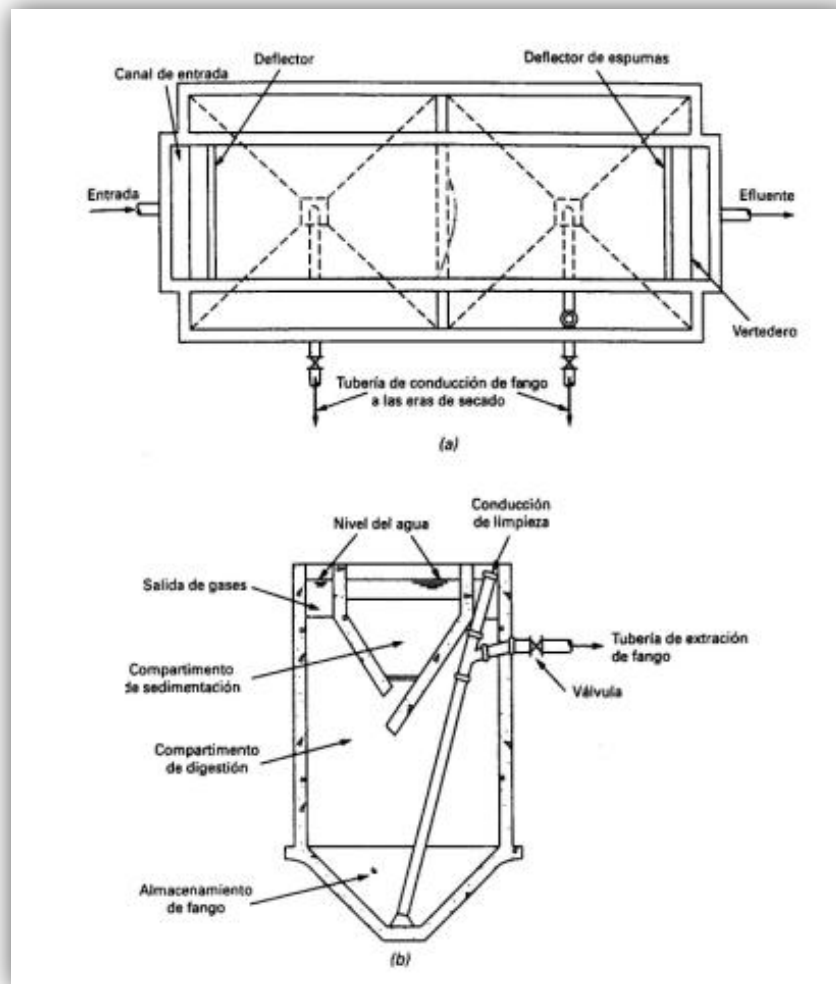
Tanque imhoff típico (a) planta, (b) sección
